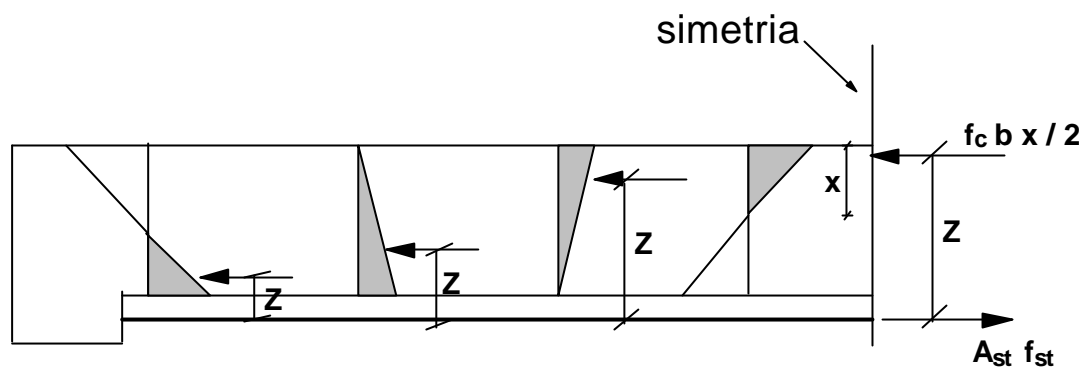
Diagrama de tensões no concreto em diversas seções da viga de armadura exposta
